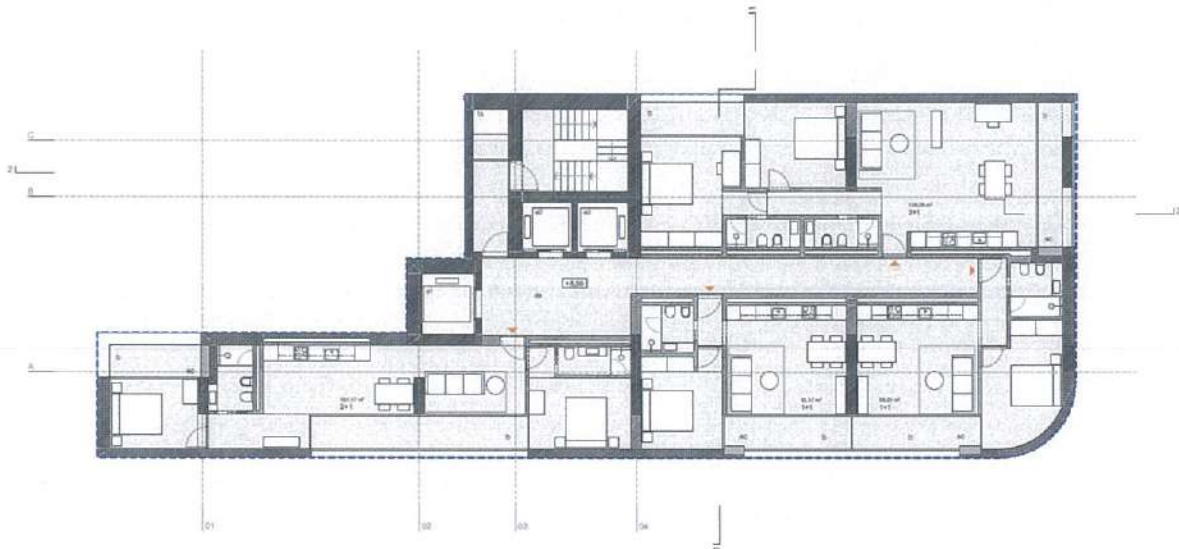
Planimetria e katit TIP te banimit per katet 2,4
